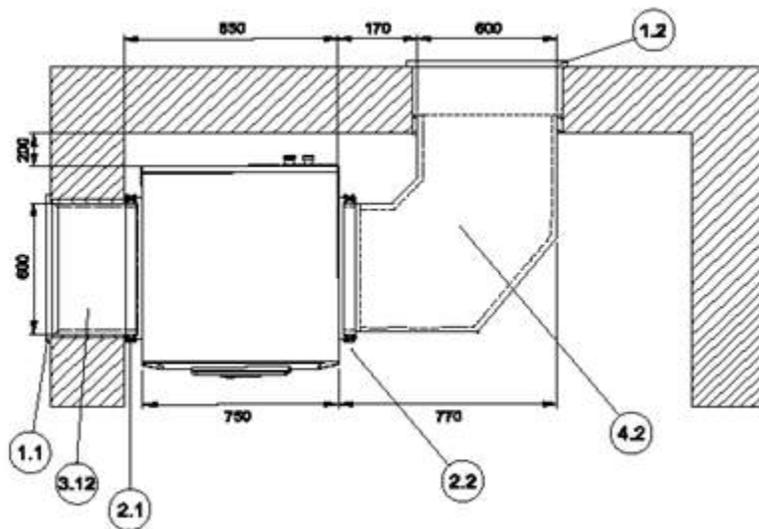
Vista dall'alto - LI 11TES (installazione a parete - condotto aria lato mandata)
